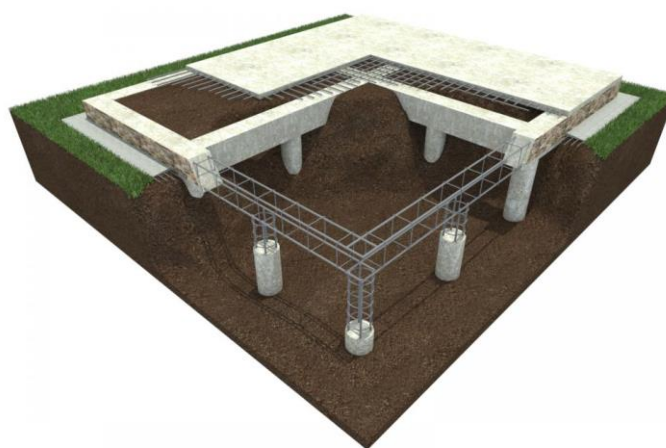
3д визуализация монолитной железобетонной плиты с ребрами жесткости на буронабивных сваях
